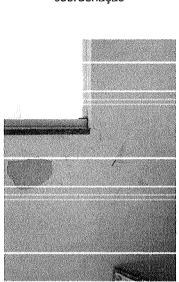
Trinca e infiltração na parede da sala de coordenação
